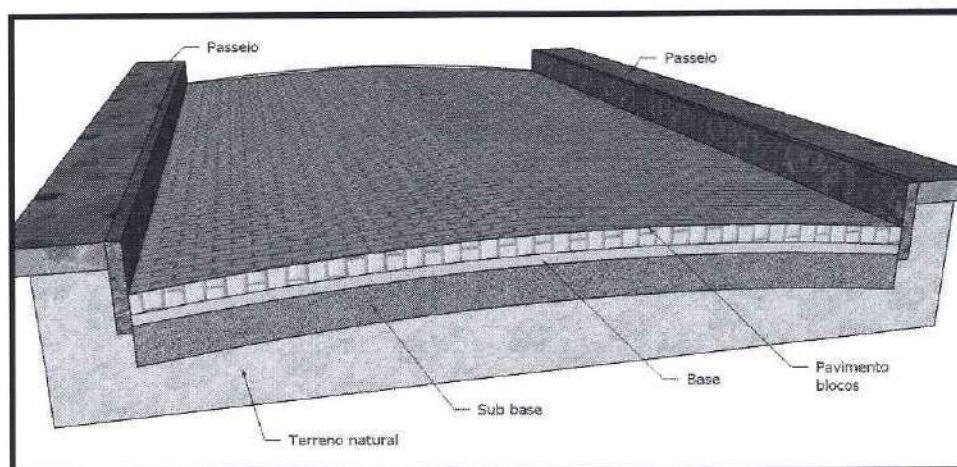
Desenho esquemático do perfil transversal da pavimentação
